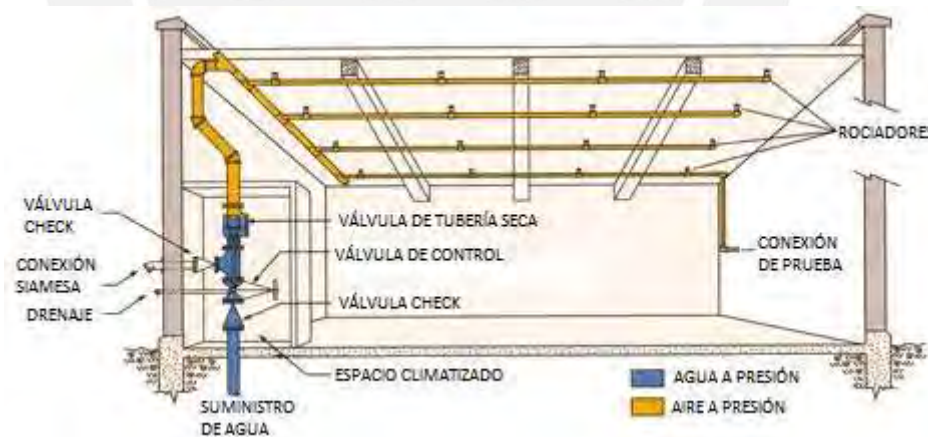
Sistema de tubería seca. Fuente: [16]
